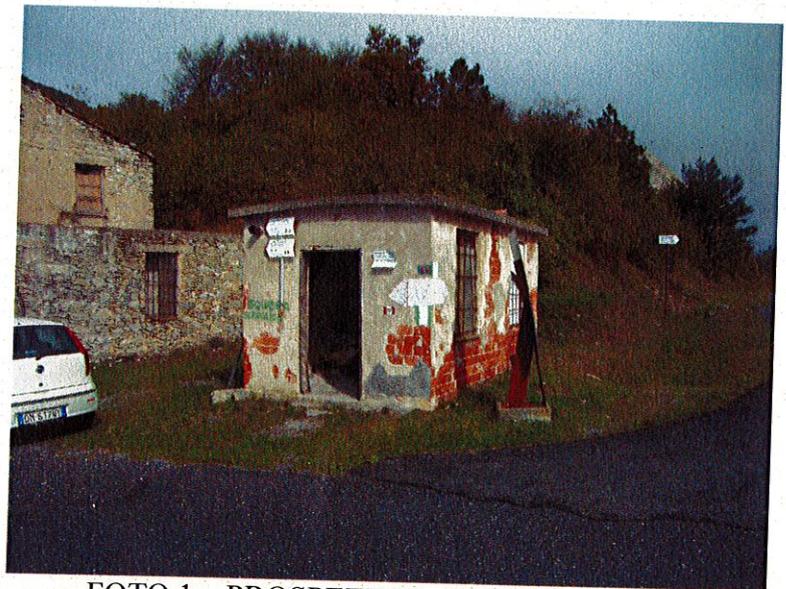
PROSPETTO LATO CASTELVECCHIO
